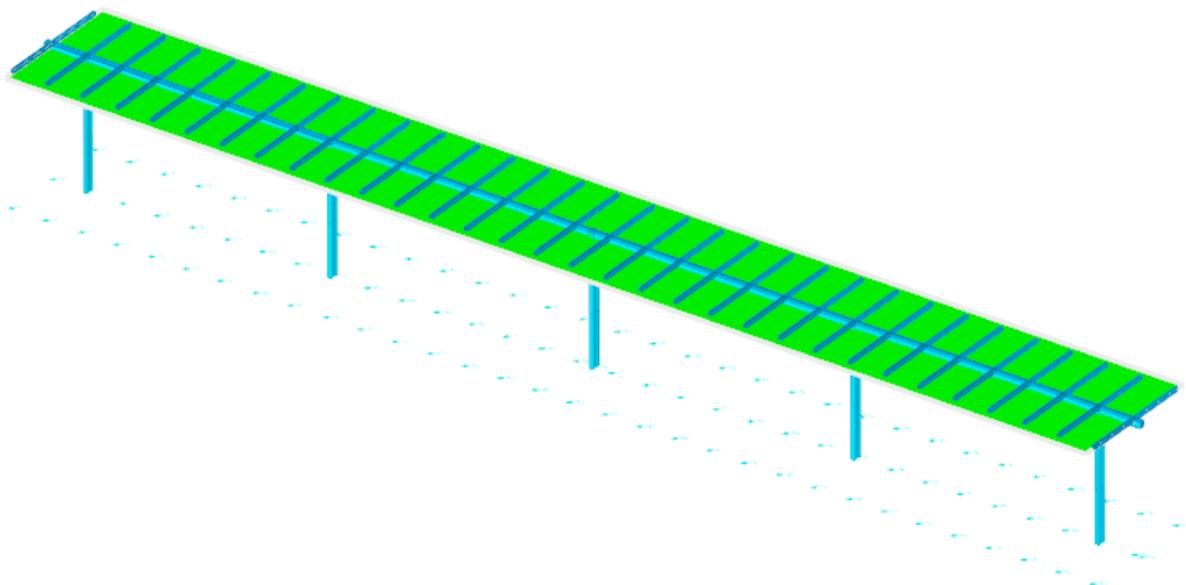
Vista assometrica modello strutturale con posizione della "vela" orizzontale
